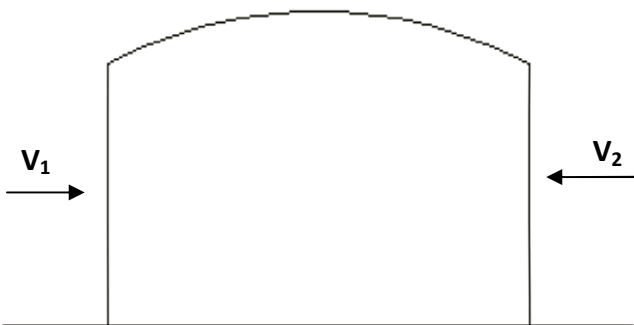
Vent sur façade principale et secondaire de la salle
